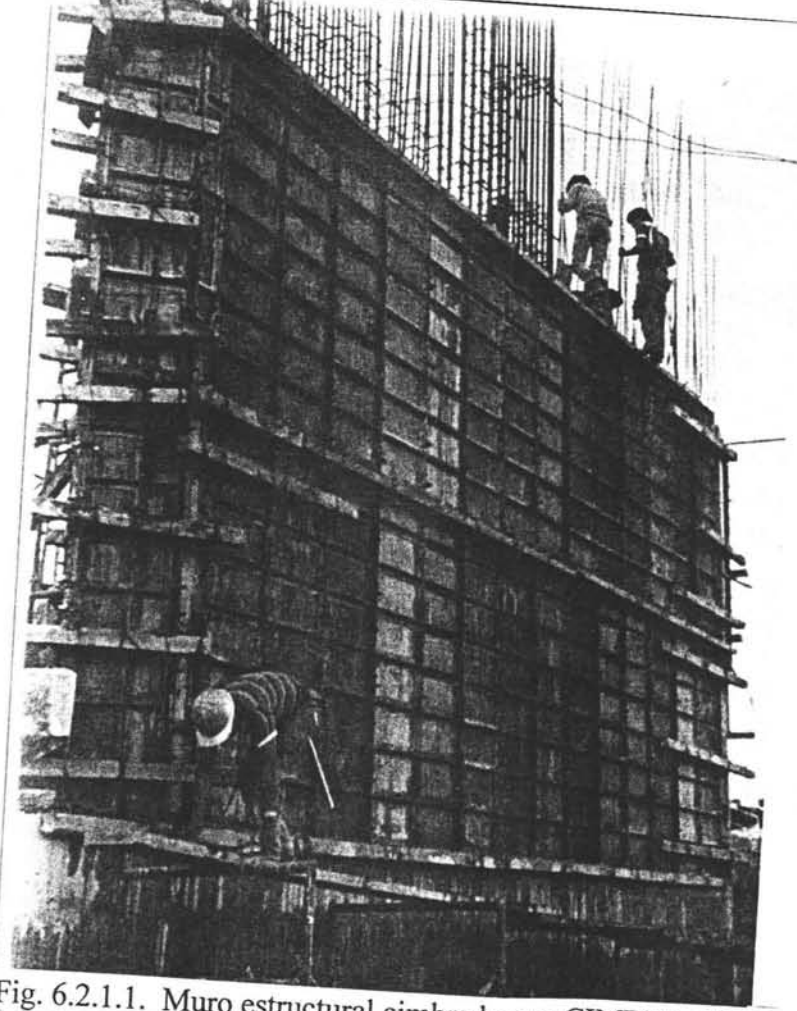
Muro estructural cimbrado con CIMBRA-MEX.
